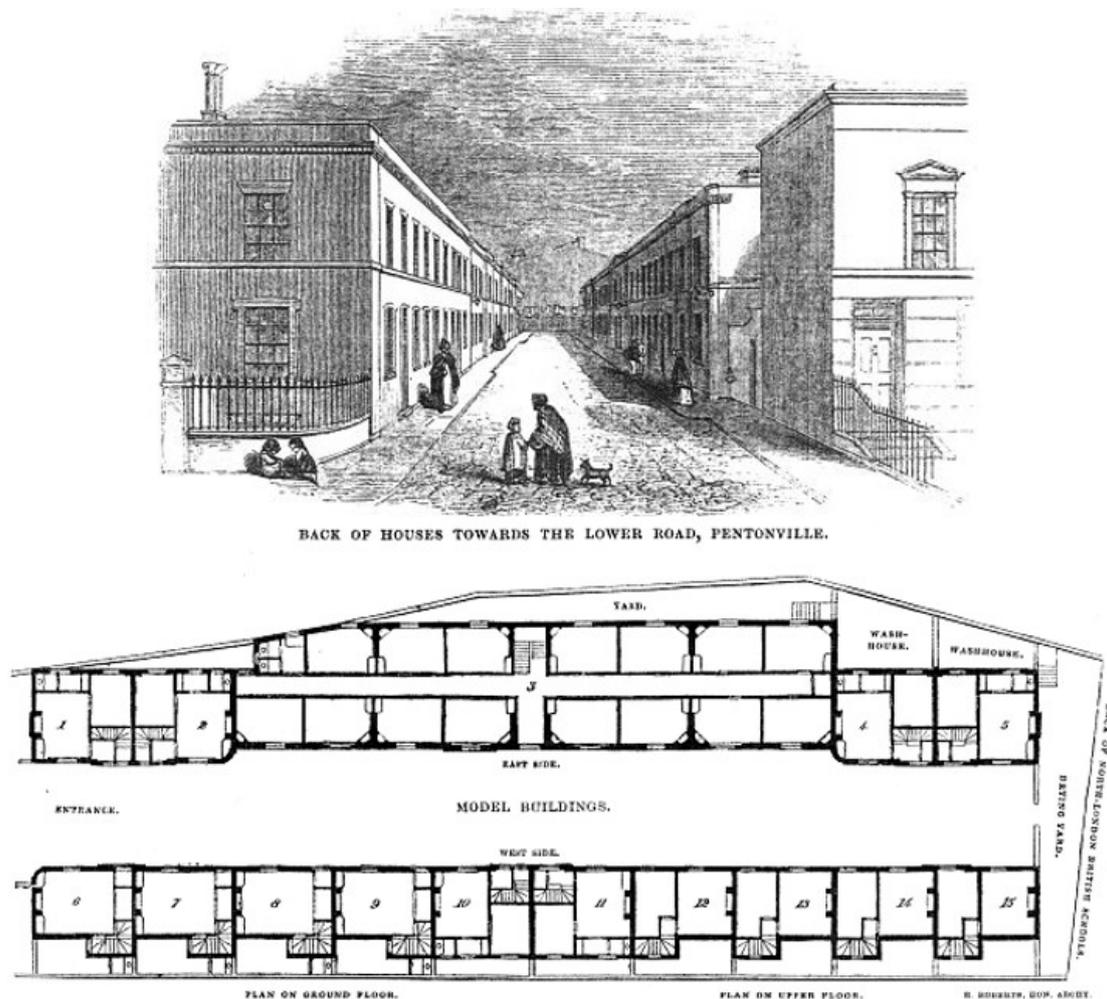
Perspectiva e planta baixa de Edifícios Modelo Bagnigge Wells, (1845)
